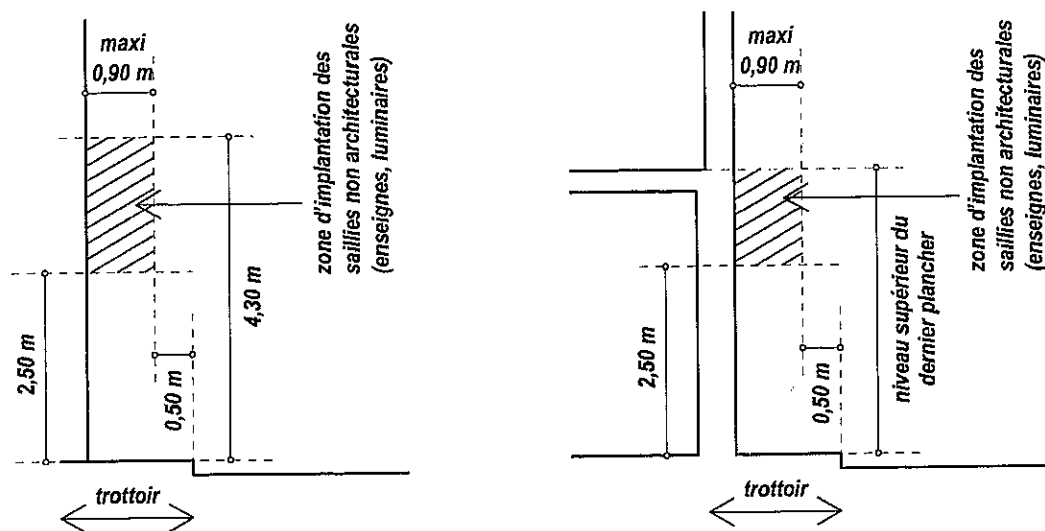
Implantation des saillies non architecturales en façade (enseignes et luminaires)
